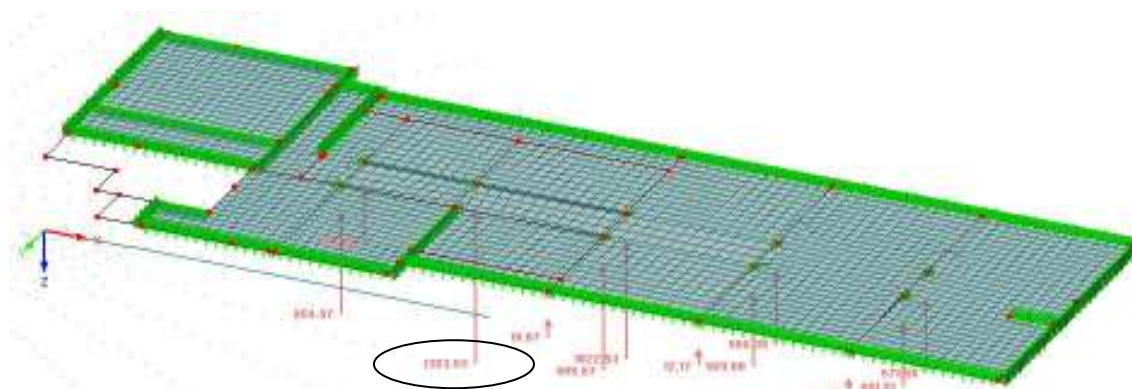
Zatěžovací stavy 2D
